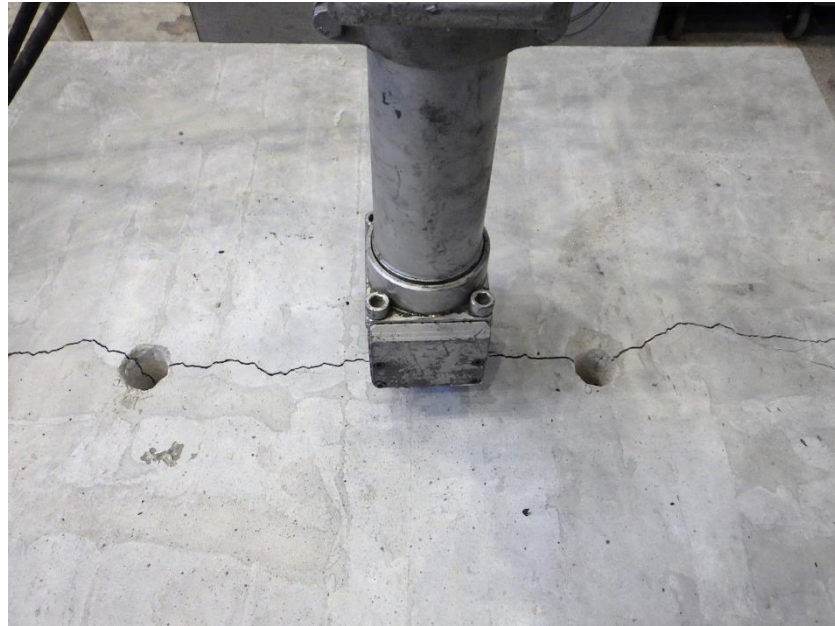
ひび割れ発生状況 (2mm 以上)
